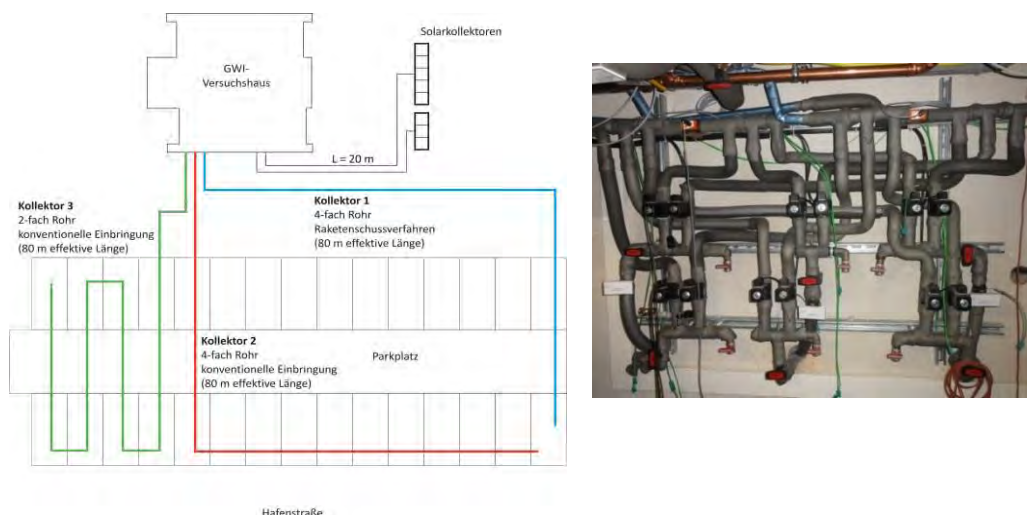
Vor dem Versuchshaus verlegte Flächenkollektoren und Hydraulik zur Umschaltung der Flächenkollektoren
